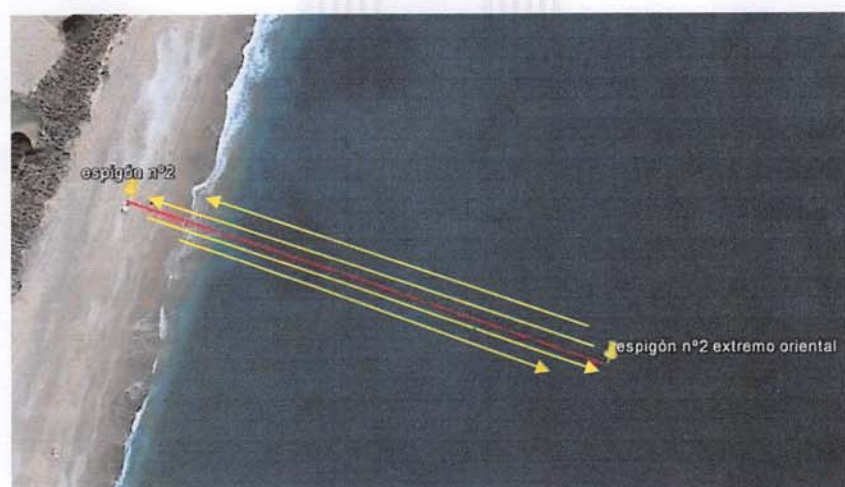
b- Detalle de ubicación del eje central longitudinal y trazado de las prospecciones en cuatro calles. Espigón nº2
